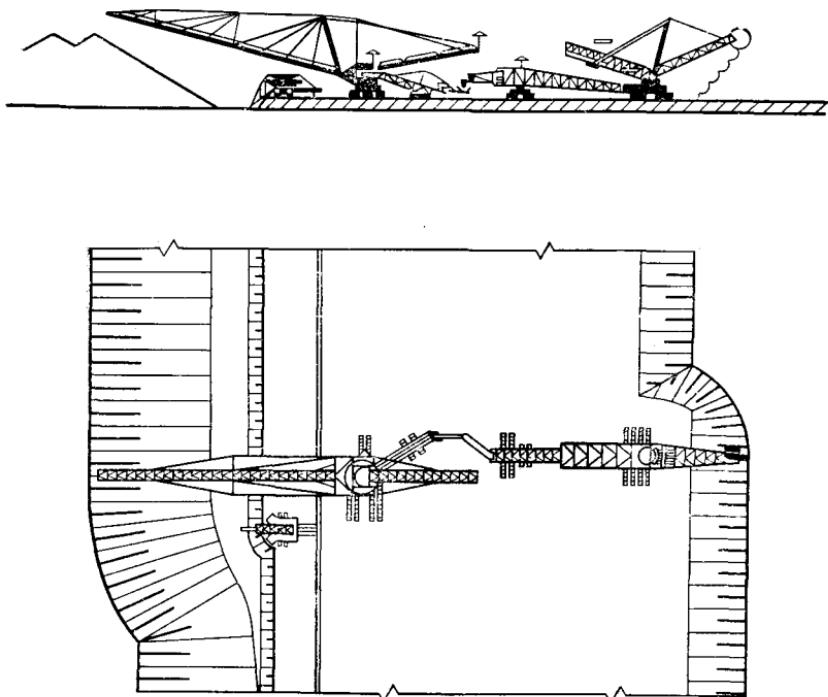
Схема расположения в карьере роторного экскаватора и консольного отвалообразователя
